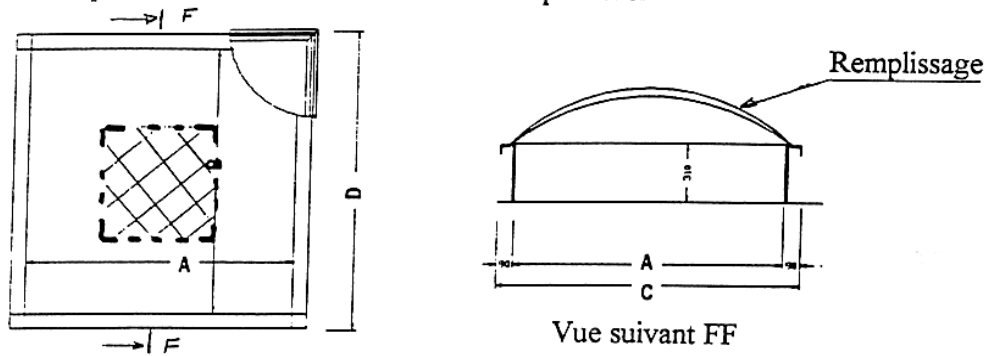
Exemple de zone de test sur un lanterneau ponctuel rectangulaire
